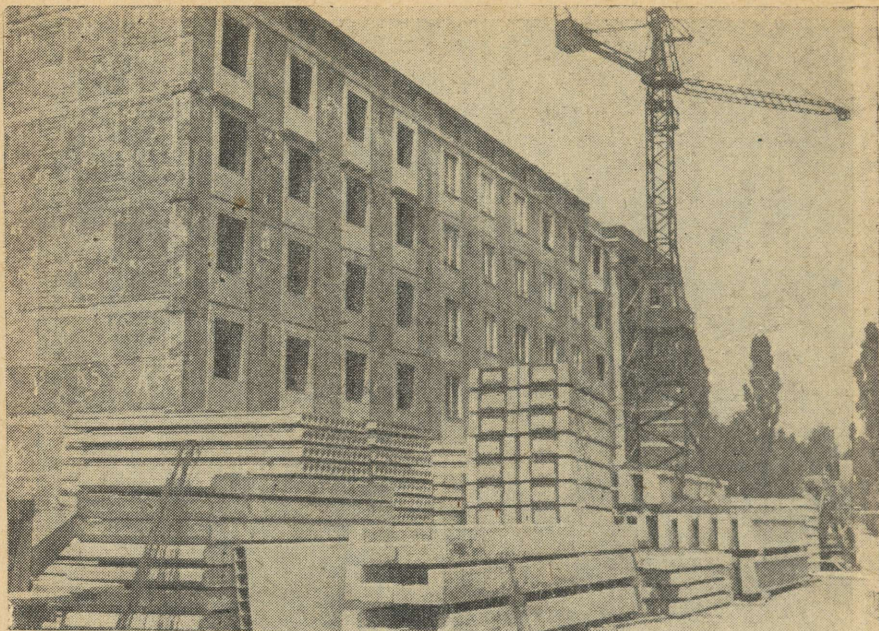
Монтаж жилого дома из кирпичных блоков (с внутренним каркасом). На первом плане железобетонные детали.
